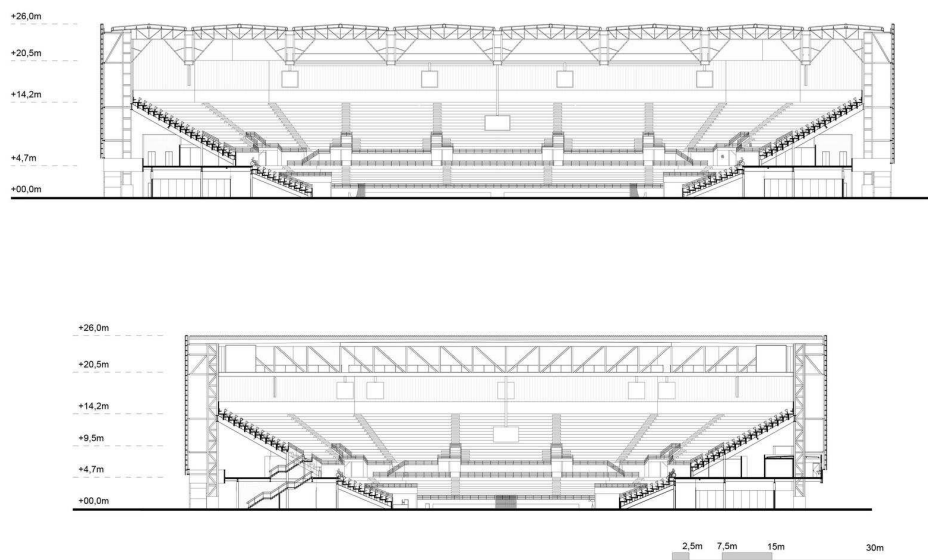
Продольный и поперечный разрез стадиона
